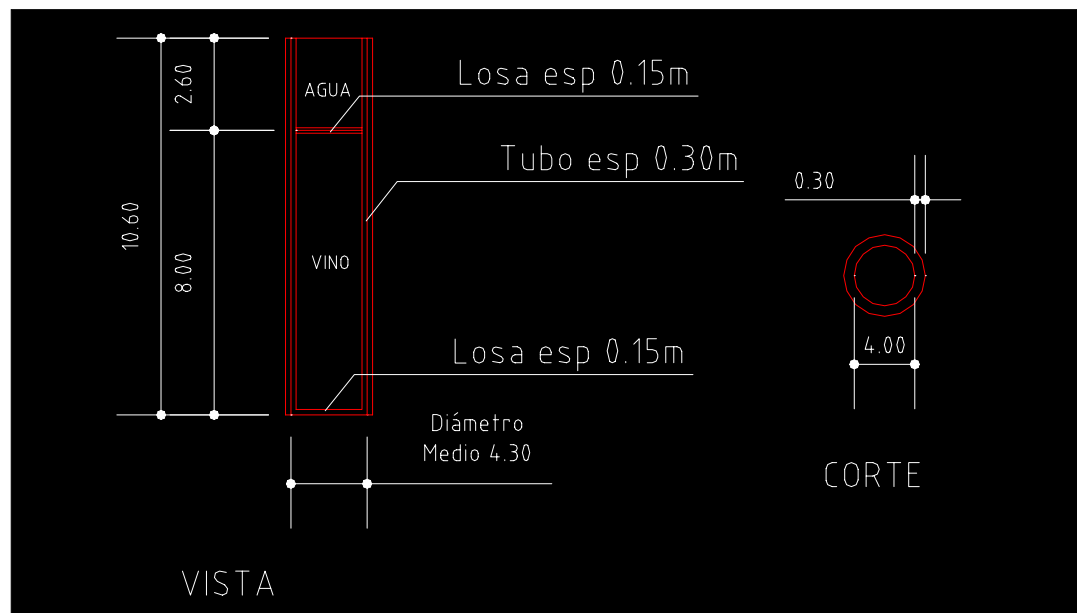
Esquema del Tanque de Hormigón Armado
